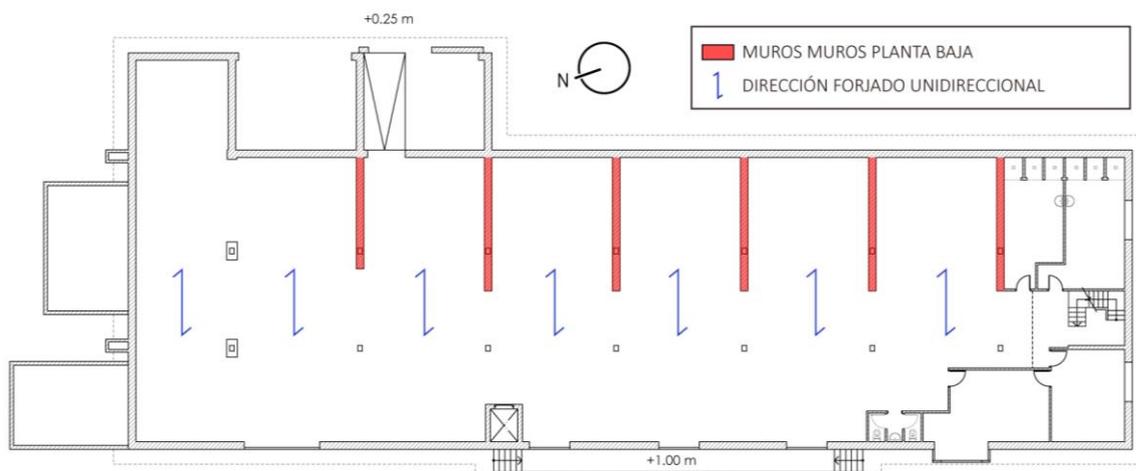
Esquema muros transversales en planta baja, nave I. Fuente: elaboración propia.
